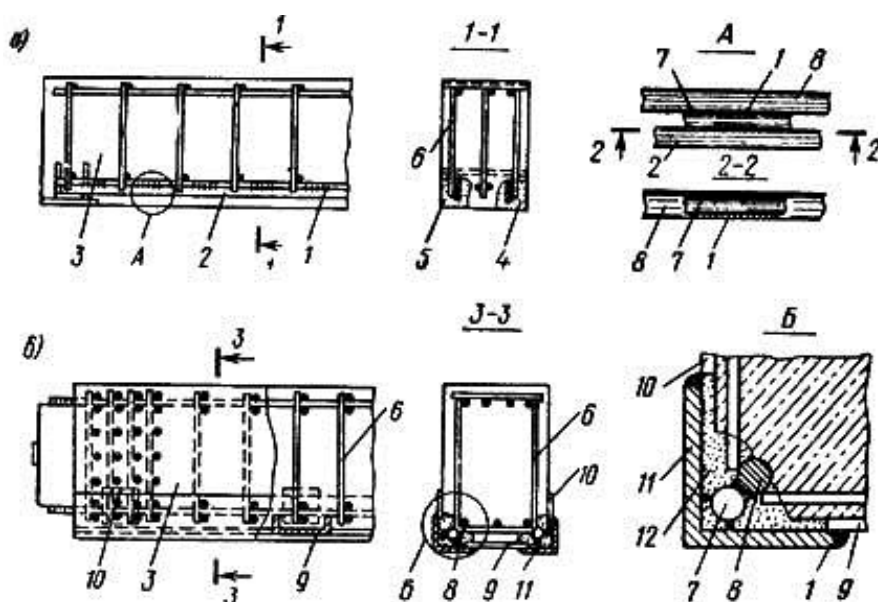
Усиление балок полуобоймами: а – добавление стержневой арматуры; б – усиление наружной уголкового обоймы, приваренной к существующей арматуре; 1 – сварные швы; 2 – добавочная арматура усиления; 3 – усиливаемый элемент; 4 – сколотый бетон защитного слоя угловых стержней с последующим его восстановлением; 5 – защитное покрытие из перхлорвинилового лакокрасочного материала; 6 – поперечные стержни крайних сварных каркасов; 7 – стержни – прокладки-коротыши; 8 – угловые стержни крайних сварных каркасов; 9 – соединительные планки обоймы; 10 – боковые листовые прокладки; 11 – уголки обоймы; 12 – пространство, заполненное цементным раствором; 13 – листовая диагональная прокладка
